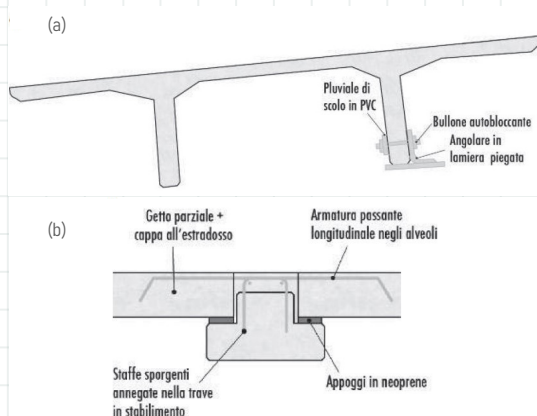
possibili soluzioni di collegamento impalcato/trave: a) collegamento tegolo/trave mediante bulloni e squadretta metallica.; b) collegamento lastra alveolare/trave a T rovescio mediante getto parziale in opera e barre metalliche annegate (RDB, 2004).
